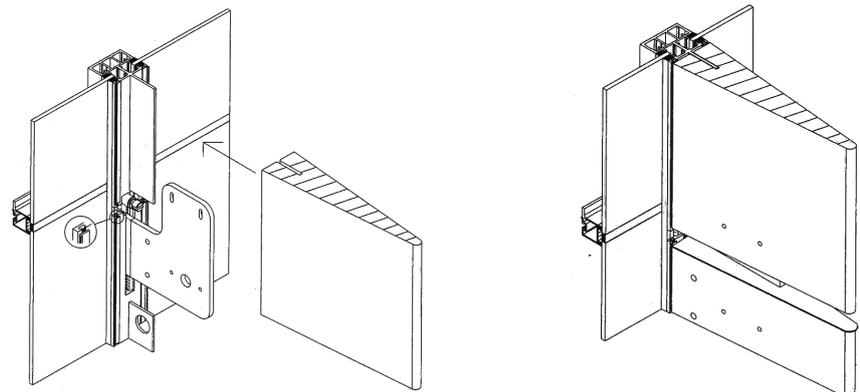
Derecha arriba: Dibujo de alzado frontal exterior. Derecha abajo: Detalles de unión de lamas de madera a subestructura de aluminio de la fachada; Abajo: corte horizontal de fachada.
